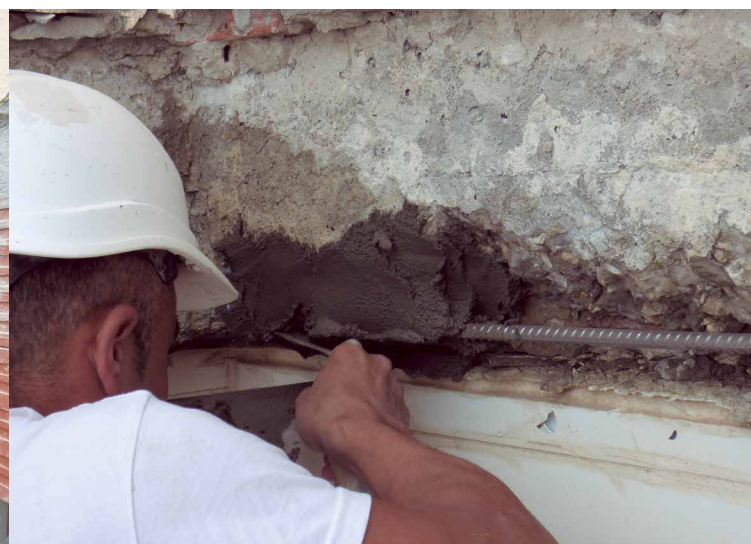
Retacado y regeneración de volumen tras colocación de barra de acero inoxidable
